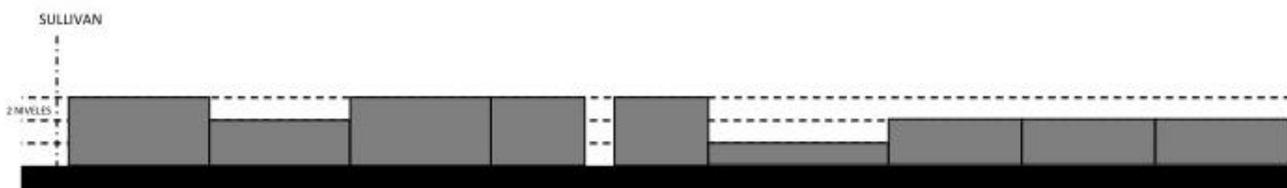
Perfil urbano que muestra las alturas sobre Sadi Carnot en dirección norte-sur después de calle Sullivan.
